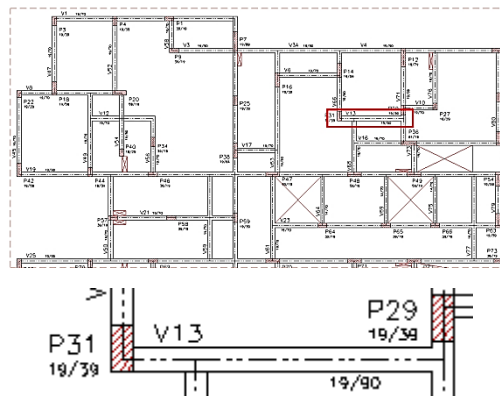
Edifício Vita Belle: localização da viga V13
